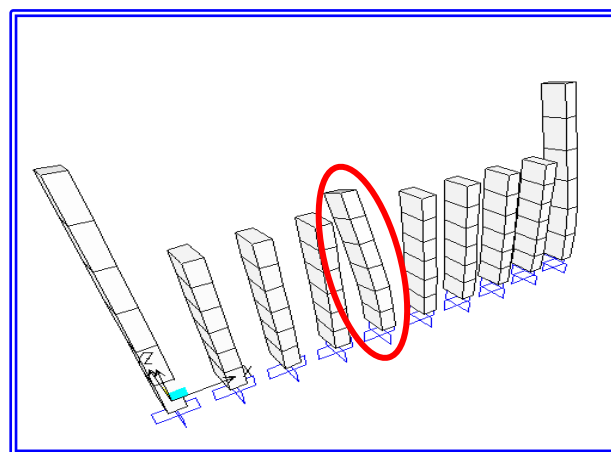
Modelo Estructural de la Presa Abierta de Concreto Armado.-
